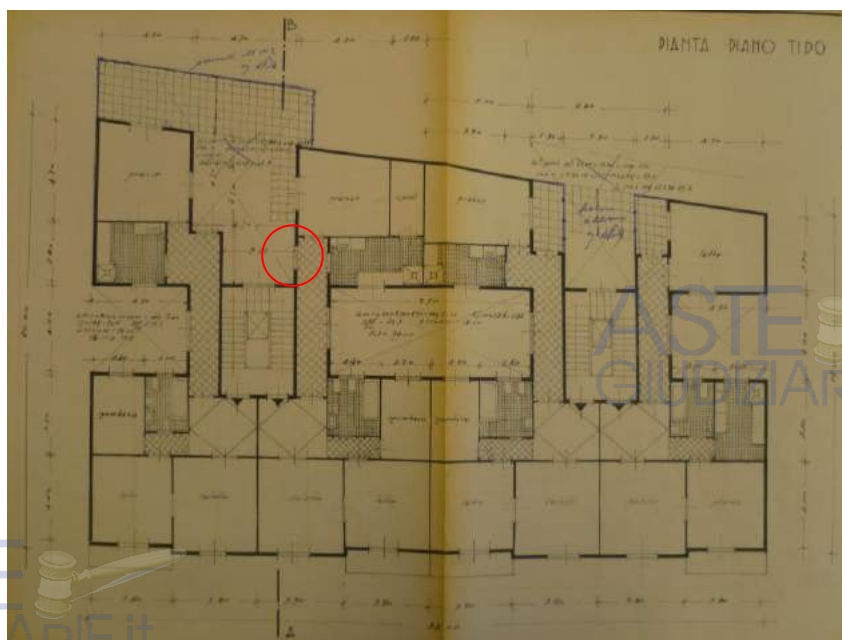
Planimetria di progetto con indicazione di una sola finestra.
